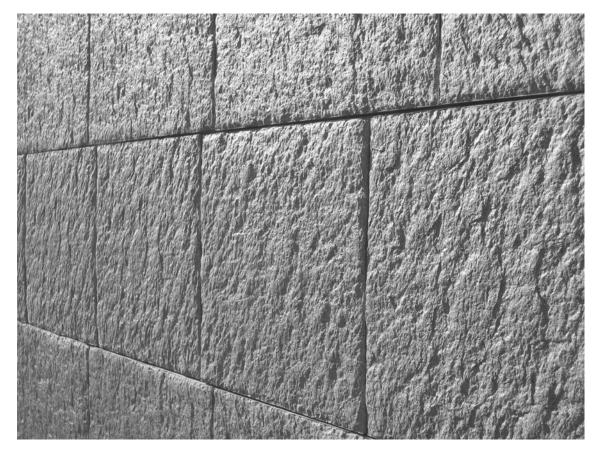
Dalles LINEA pour rez-de-chaussée exposés
